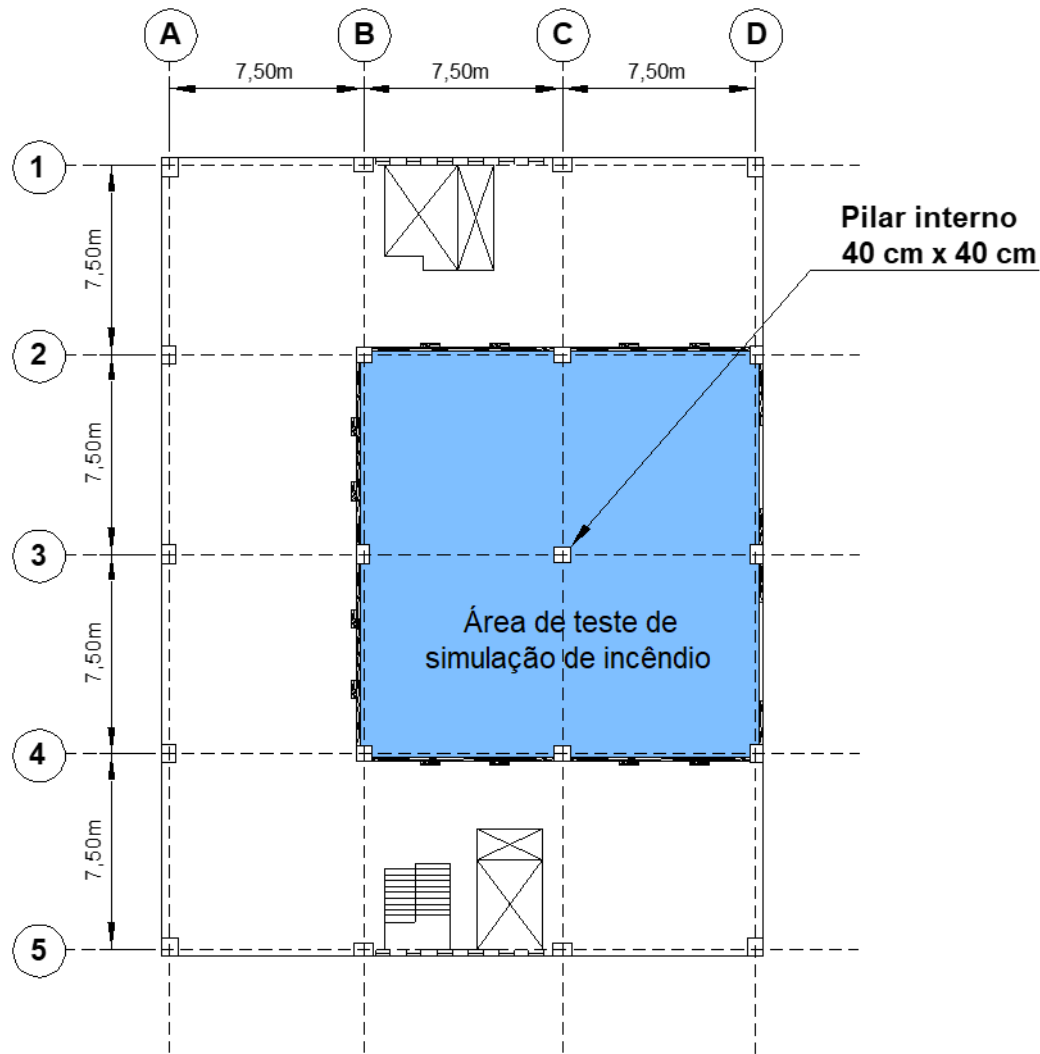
Planta da estrutura protótipo em concreto armado indicando a área submetida à simulação de incêndio (Chana & Price, 2003).
